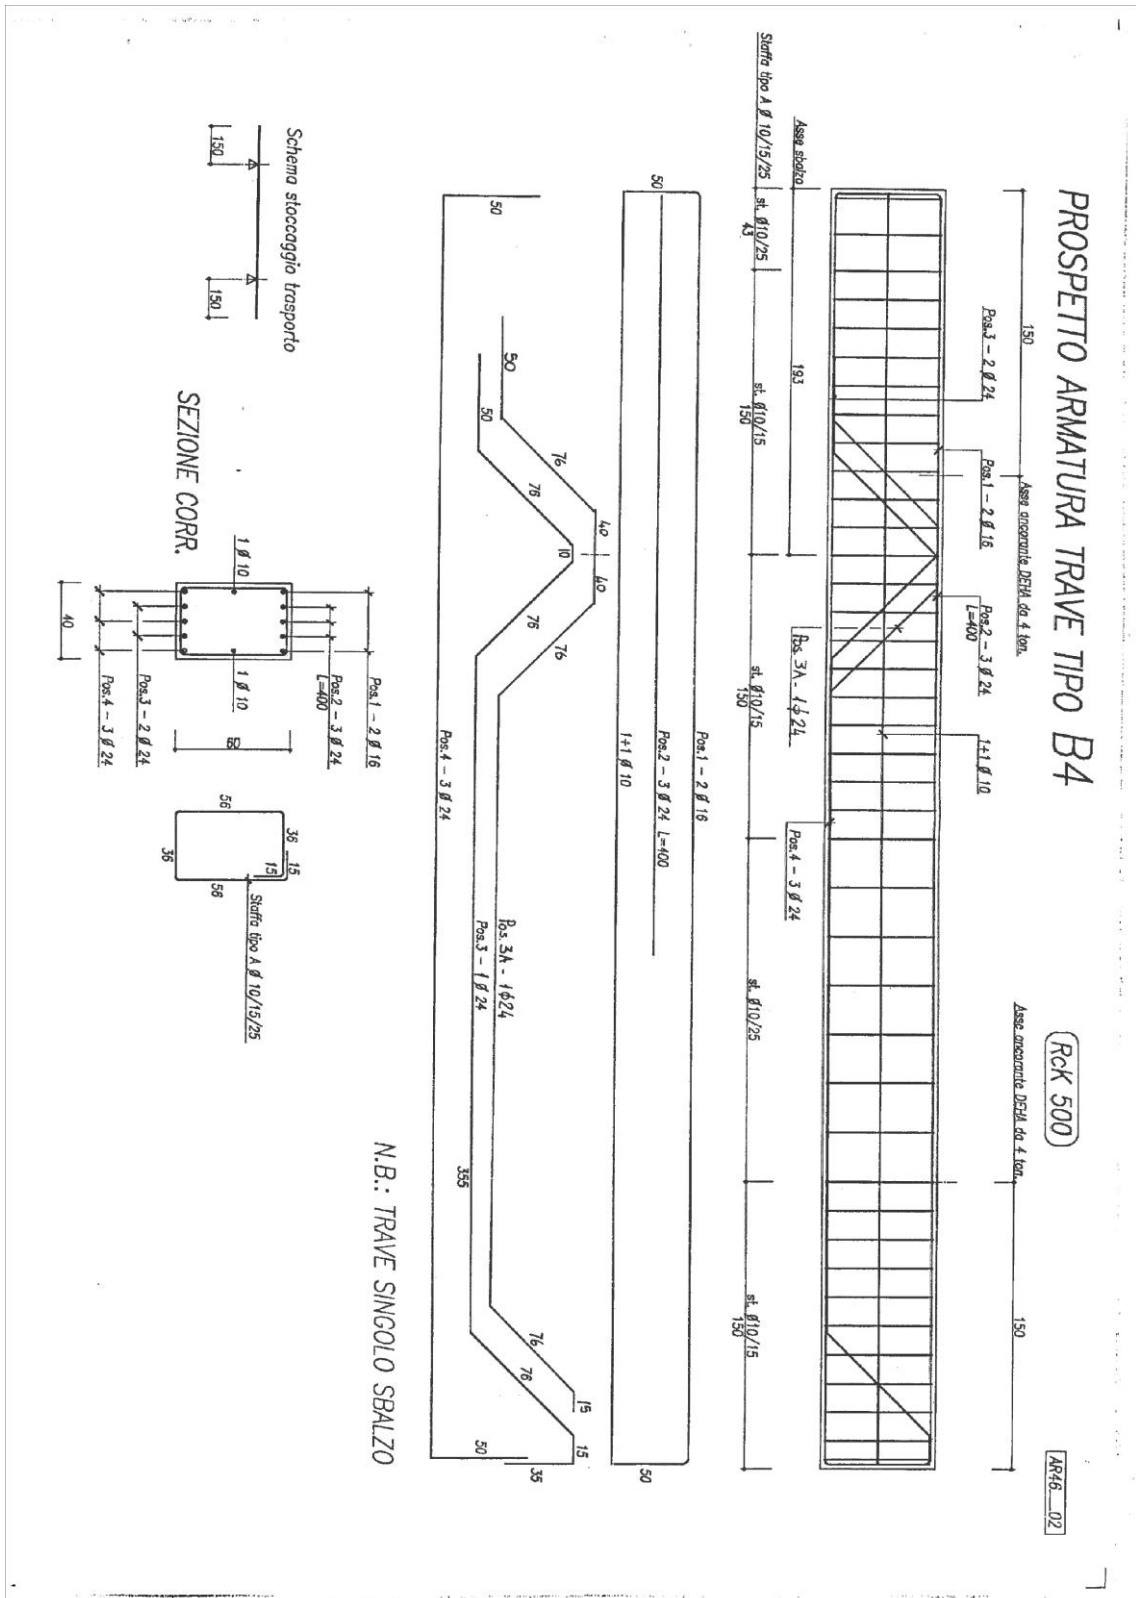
Particolare di A.1996.cap.sa.T07 - Armatura e abaco travi rettangolari 60 x 40 (piano primo) - Armatura travi tipo B4
